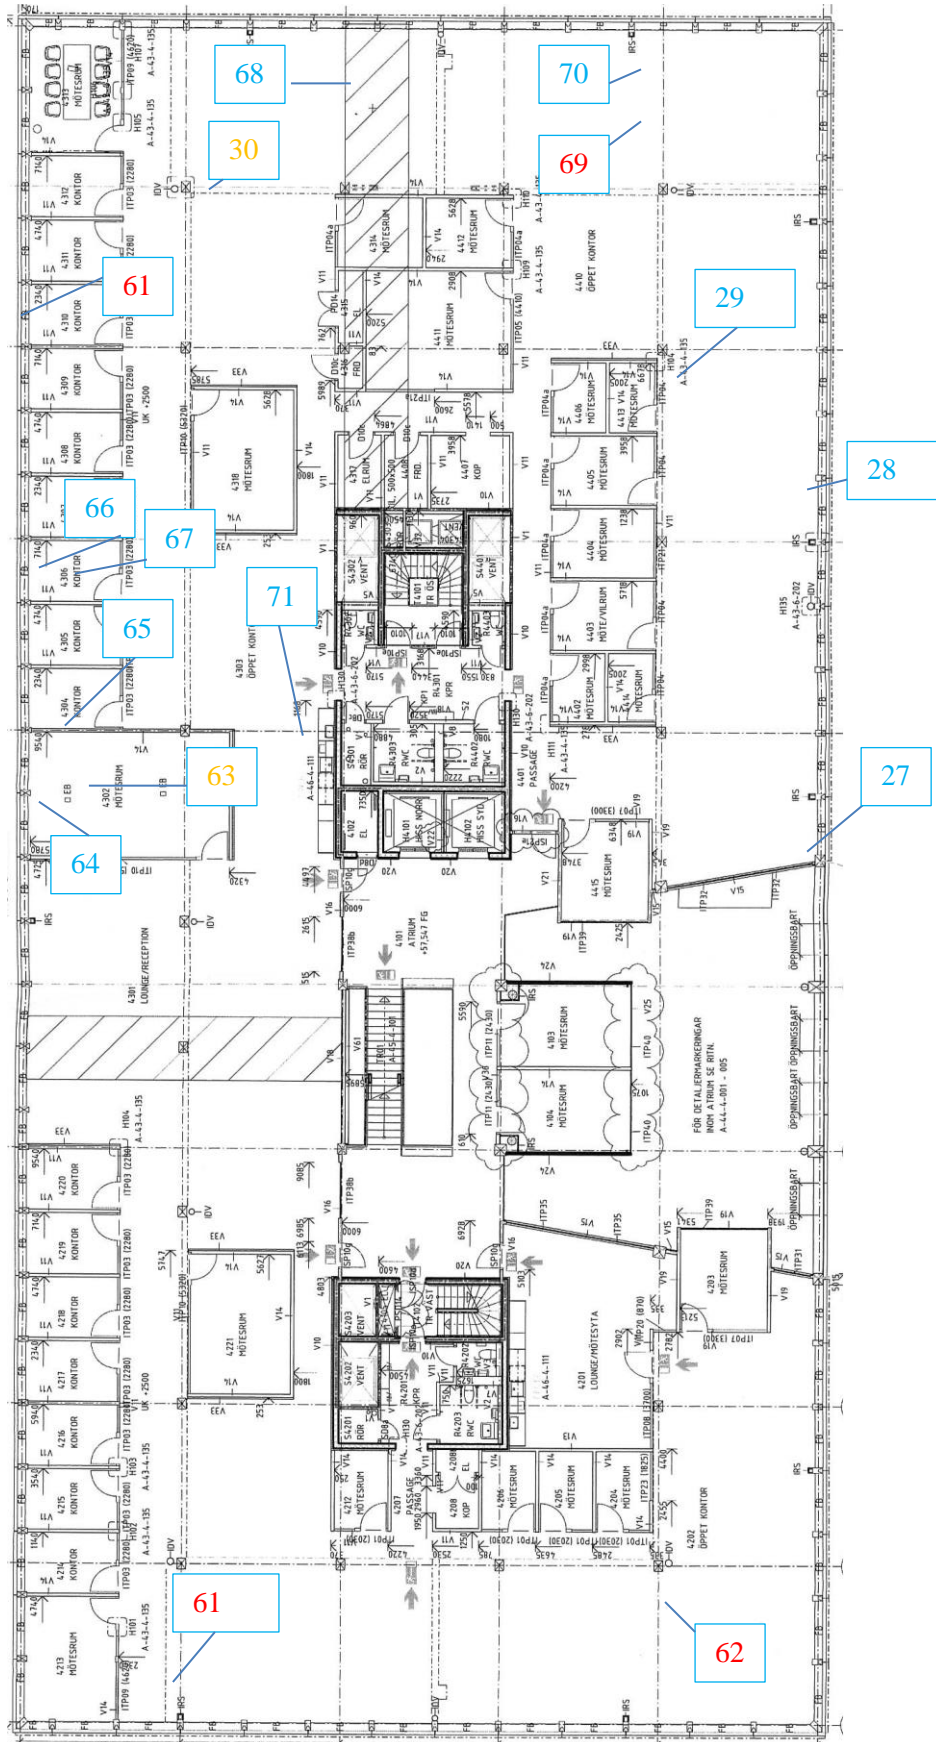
Plan 1, (Entréplan av betonggol, träpelare och ovanför finns träbjälklag 1)
